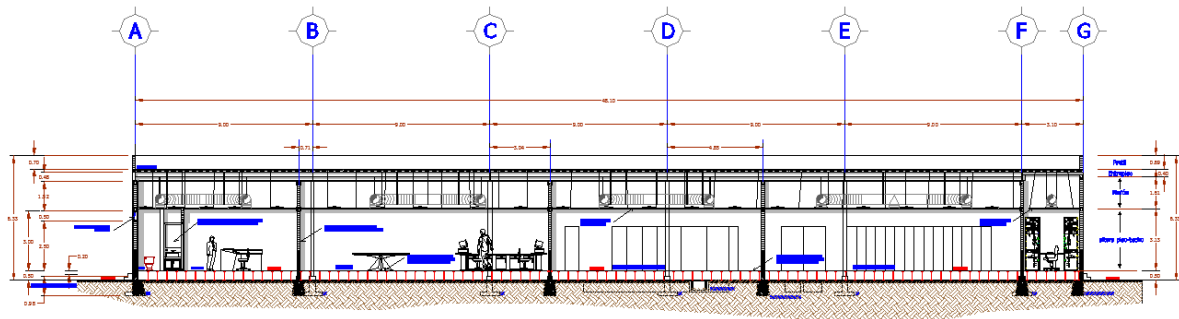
Arreglo arquitectónico de edificio eléctrico (Vista lateral)
